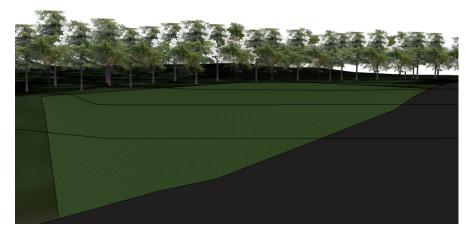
Perspectiva do levantamento planialtimétrico. Fonte: AUTORA, 2019.
